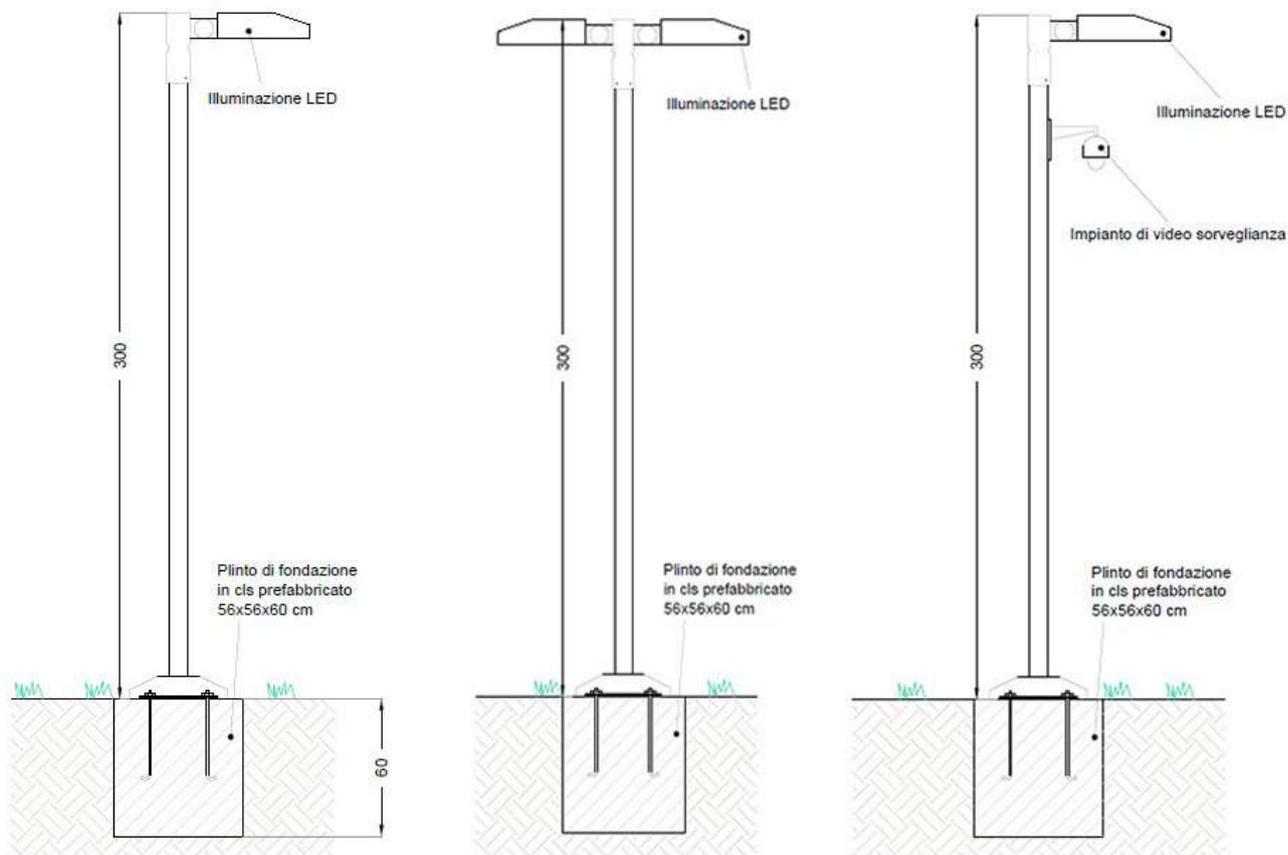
Dettagli dell'impianto di illuminazione e video sorveglianza dell'impianto misure in cm
